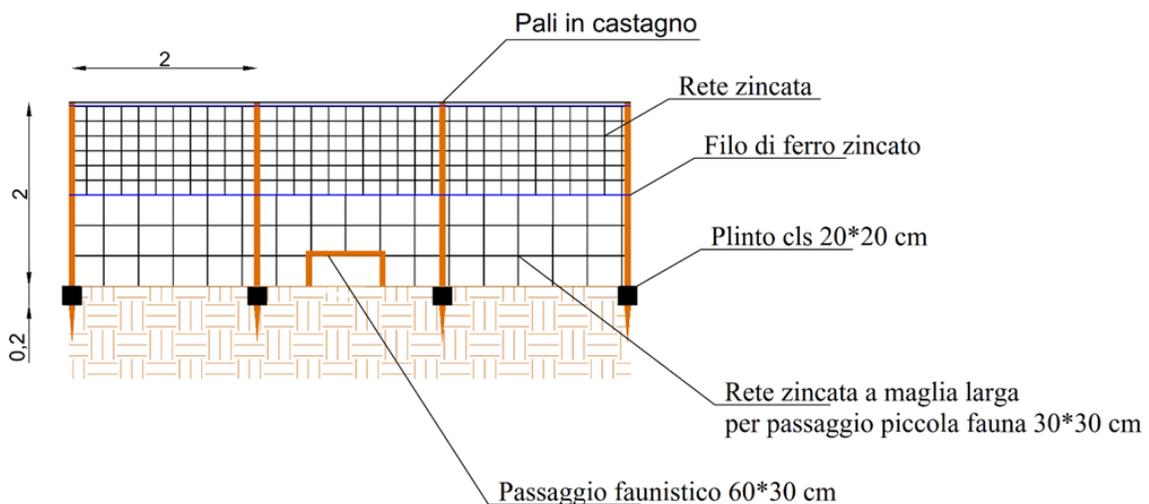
Vista dall'interno del campo. Particolare della recinzione con rete metallica e pali in legno.
